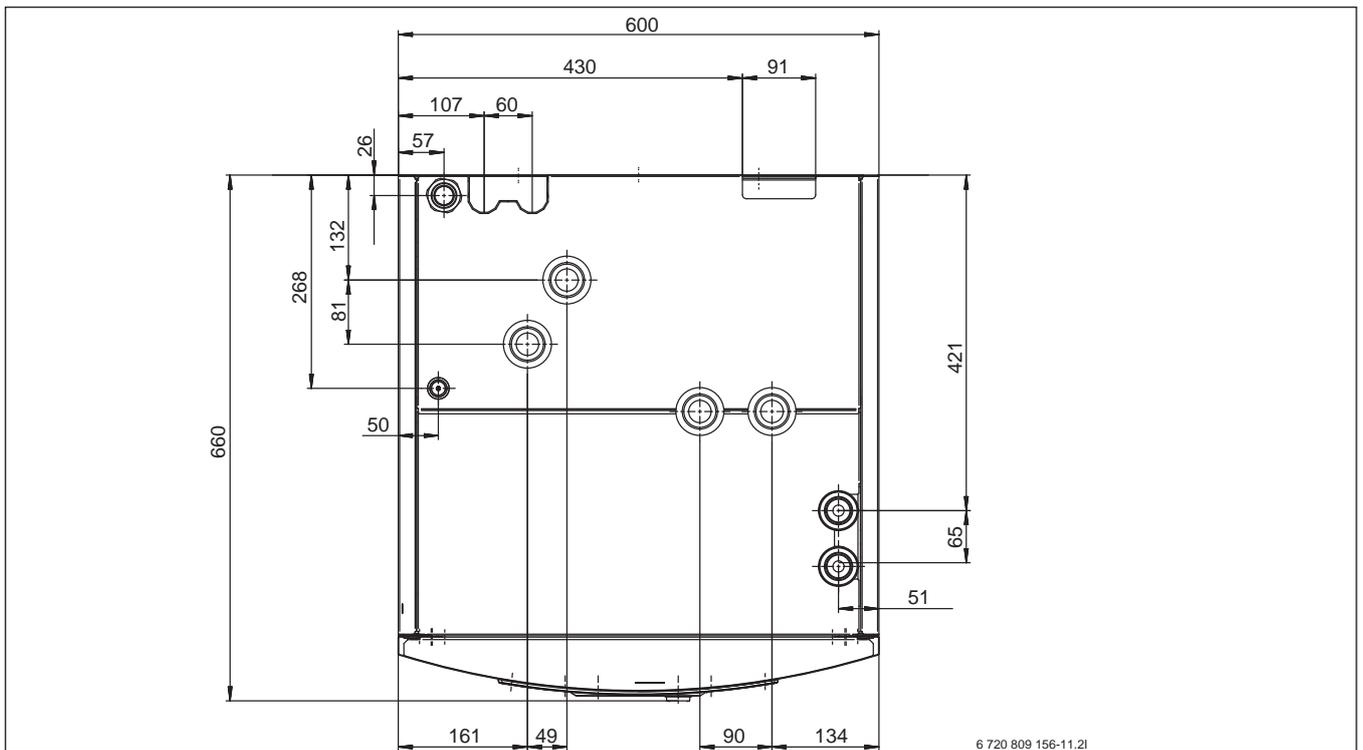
Abstände des Towers, Draufsicht (Maße in mm)
